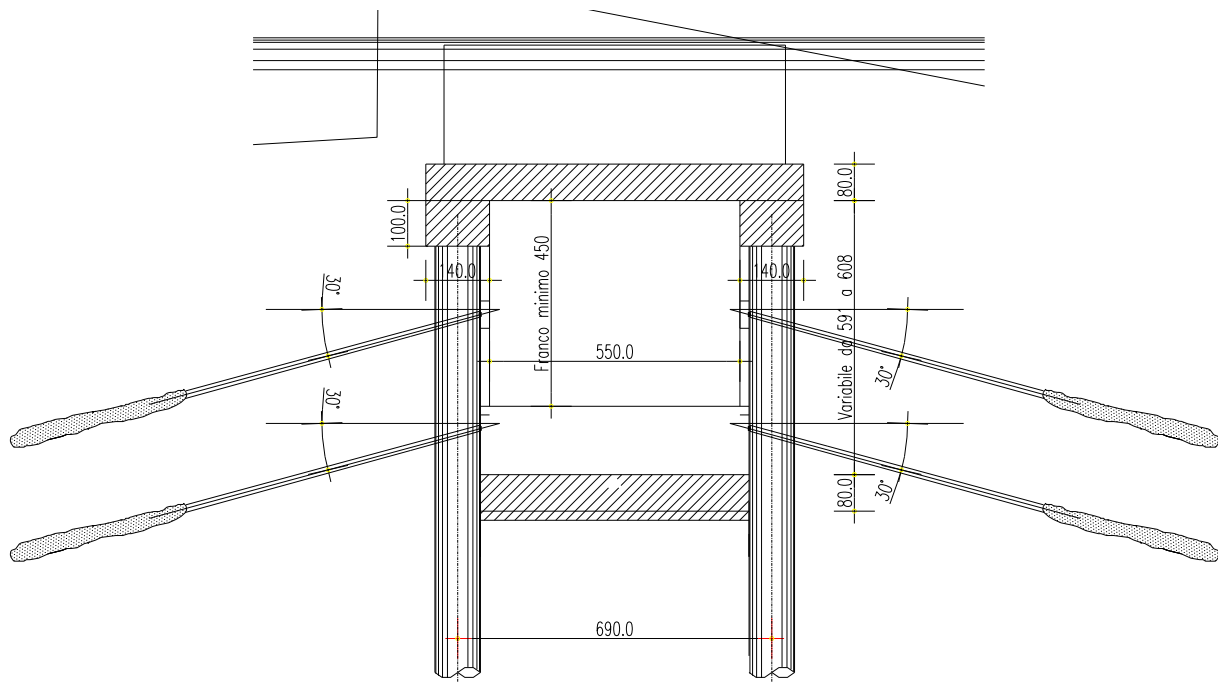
Sezione tipo sottopasso RFI lato Nord.
